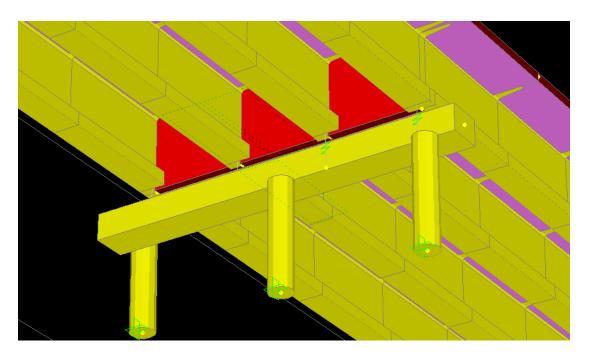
MODELO DE LA PILA UTILIZADA PARA LA INVESTIGACION
